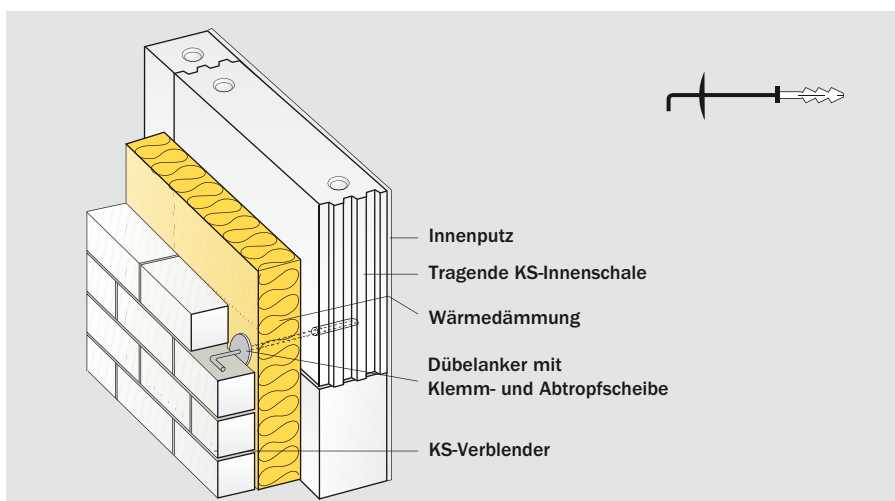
Systemaufbau zweischaliges Mauerwerk mit Wärmedämmung
